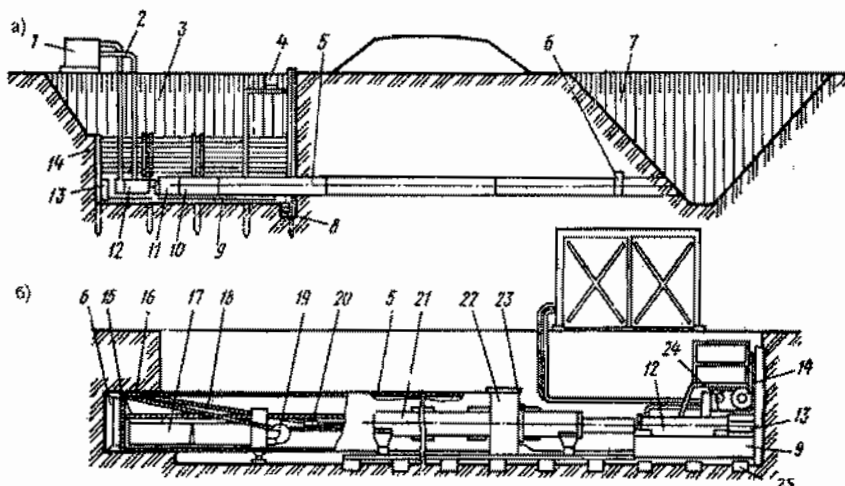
Установки для прокладки труб методом продавливания: а - продавливание с ручной разработкой грунта; б - продавливание установкой СКБ Главмосстроя с механизированной разработкой грунта; 1 - насосная станция; 2 - трубопровод; 3 - рабочий котлован; 4 - водоотводный лоток; 5 - трубопровод (футляр); 6 - лобовая обделка (нож); 8 - приемок для сварки труб; 9 - направляющая рама; 10 - нажимной патрубок; 11 - нажимная заглушка; 12 - гидродомкраты; 13 - башмак; 14 - упорная стенка; 15, 18 - каньаты; 16 - ролики; 17 - ковш; 19 - барабан-накопитель; 20 - уравниватель; 21 - нажимные штанги; 22 - траверса; 23 - поворотные фланцы; 24 - лебедка; 25 - шпалы направляющей рамы
